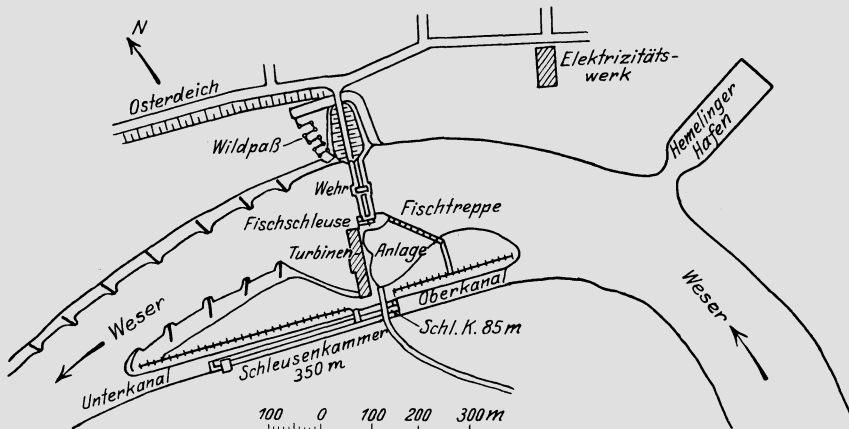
Hemelingen bei Bremen. Maßstab 1 : 15 000.
